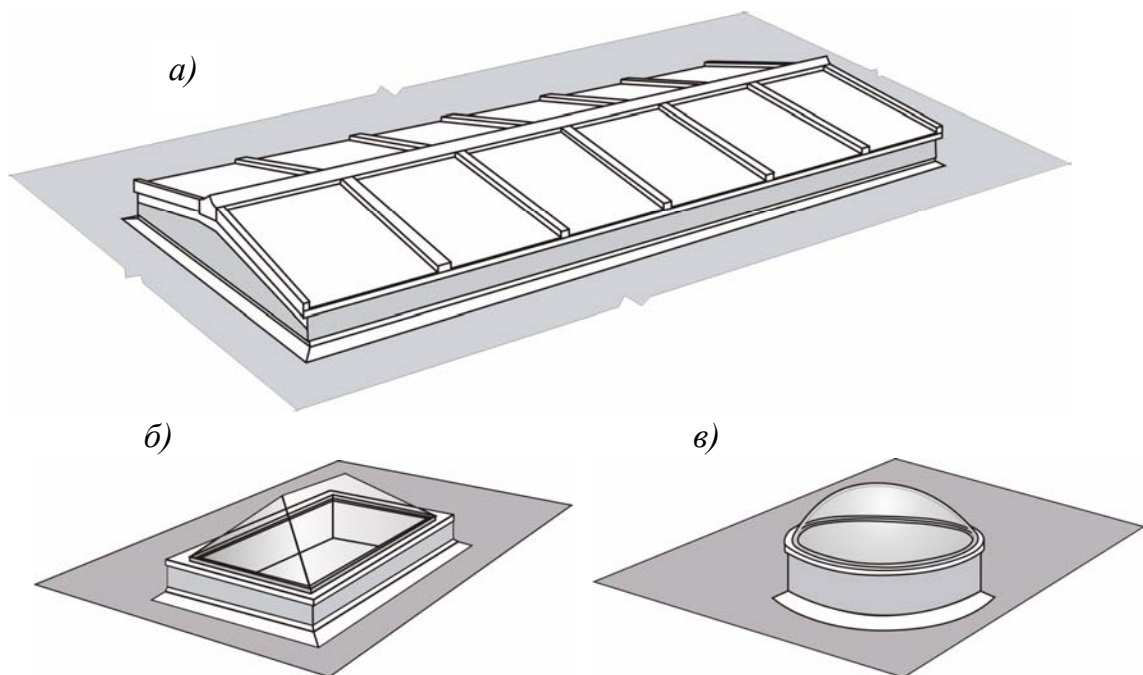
Устройство зенитных фонарей на покрытиях зданий: а – со стеклопакетами; б – плоскими светопропускающими элементами; в – с полимерными светопропускающими элементами сферической формы
